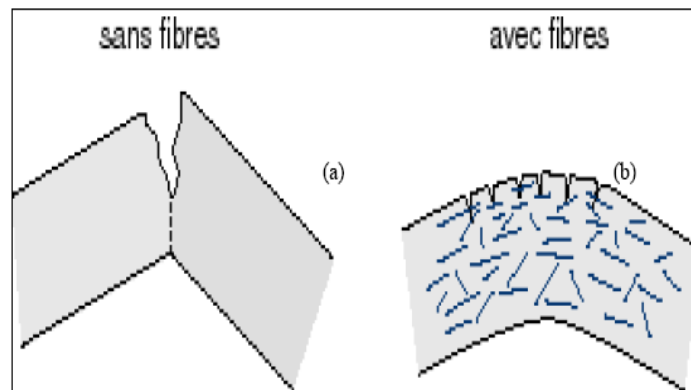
La fissuration dans : (a) le béton non armé de fibres
